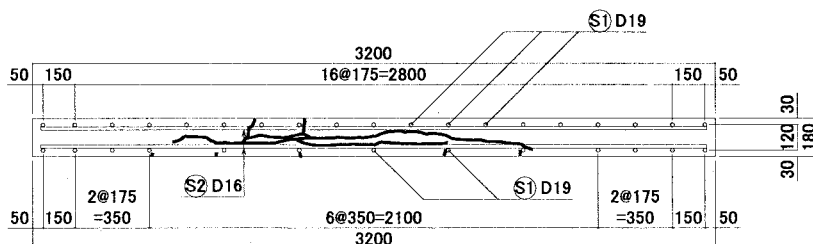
切断面のひび割れ状況 (W 床版, B-B 断面)
